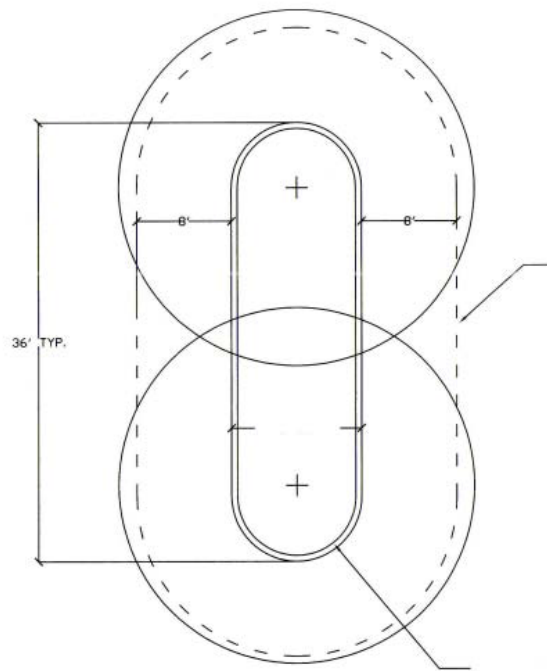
Vue en plan d'un îlot de plantation.
